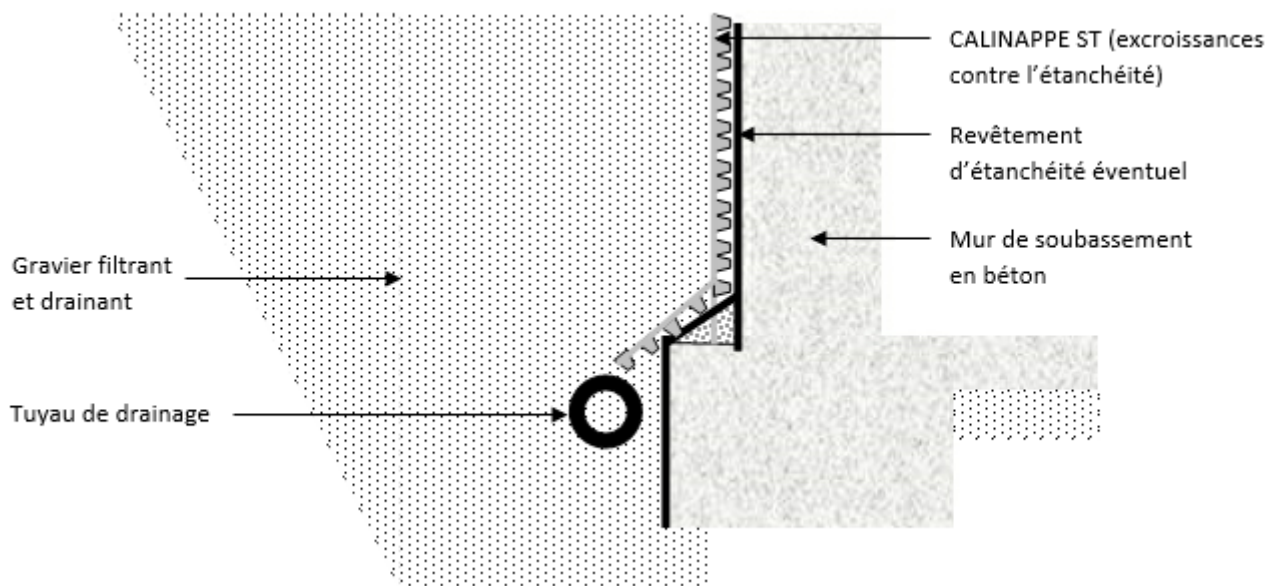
Sch ma de principe de la nappe CALINAPPE ST (coupe verticale)
